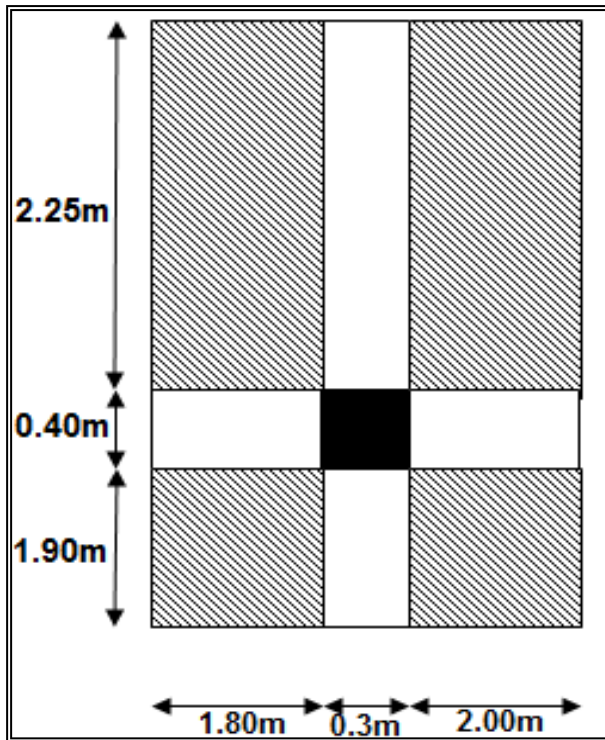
Croquis d'un poteau d'angle (A-7) Fig.II-3-2 : Croquis d'un poteau intermédiaire (E-2)
